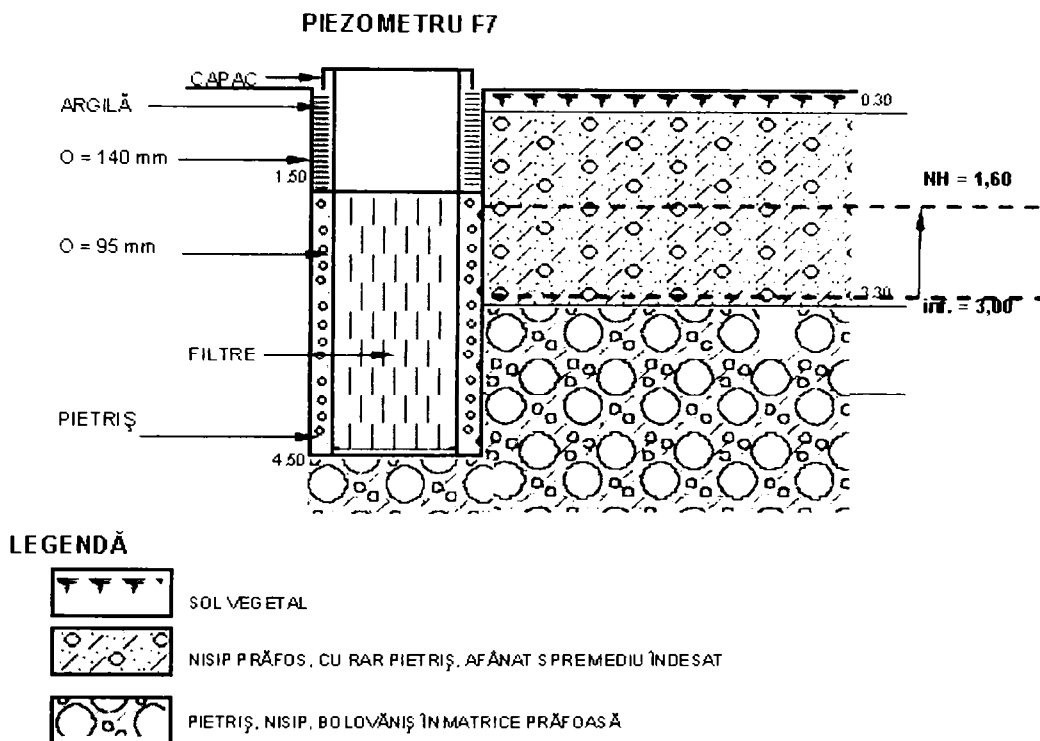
Profil transversal pentru piezometrul F7
